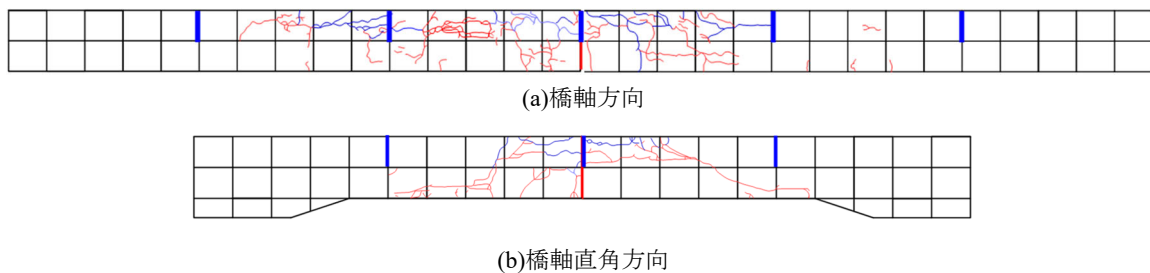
床版断面のひび割れ発生状況(本床版)
